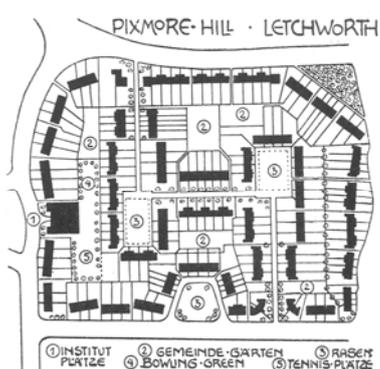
Lageplan der Gartenstadt Letchworth (l)
